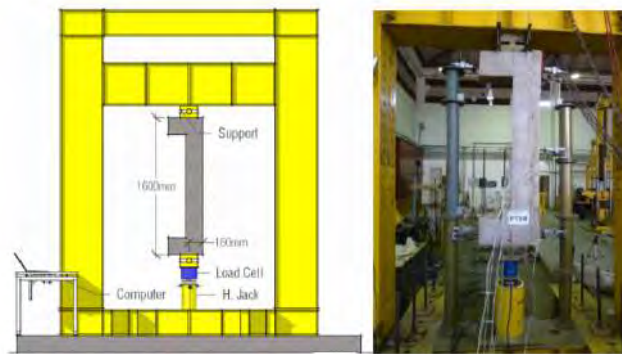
Sistema de ensayo de las columnas reforzadas con encamisado de concreto parcial
